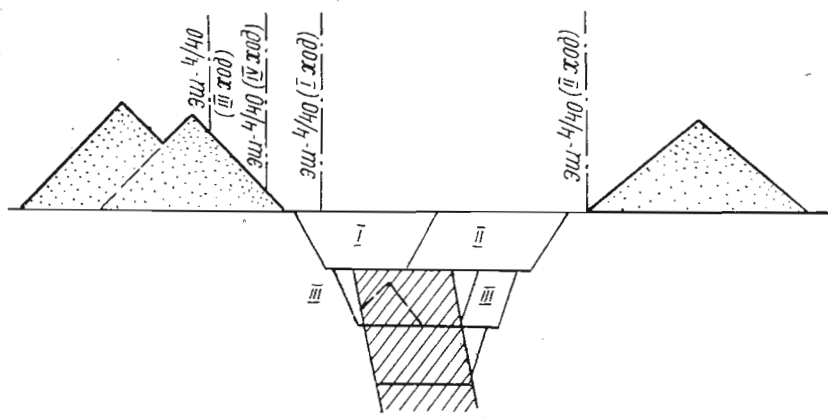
Схема отработки крутопадающего пласта по бестранспортной системе разработки
